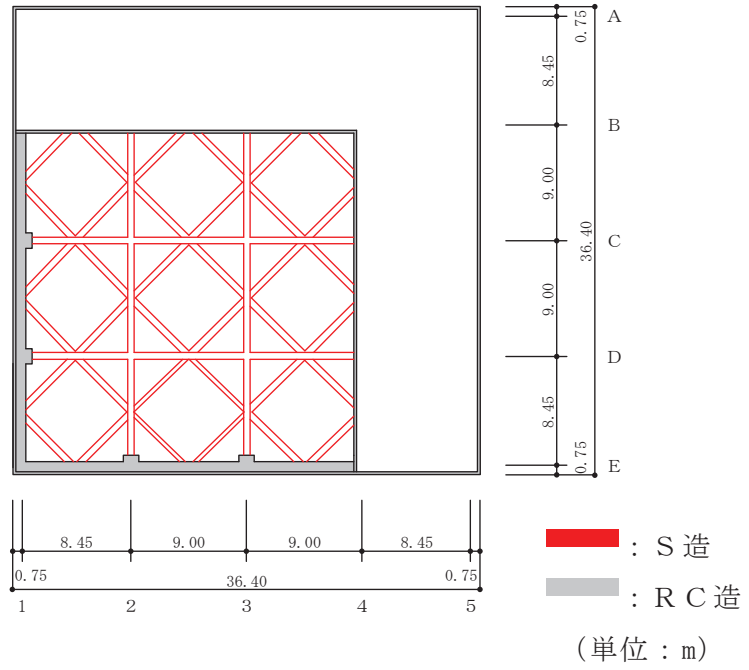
(5) 緊急時対策建屋の概略平面図 (0.P. 75.9m)
